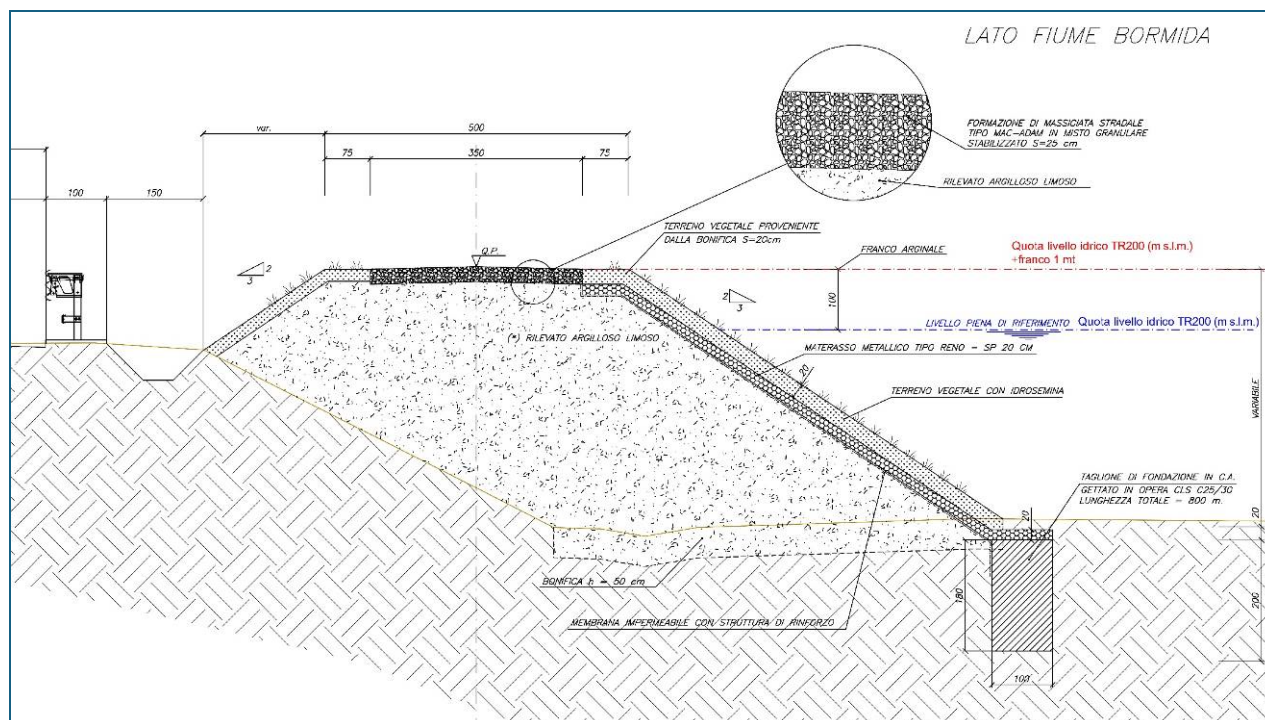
Argine sinistro, opera 5 - sezione trasversale tratto sezione 1 - sezione 12
